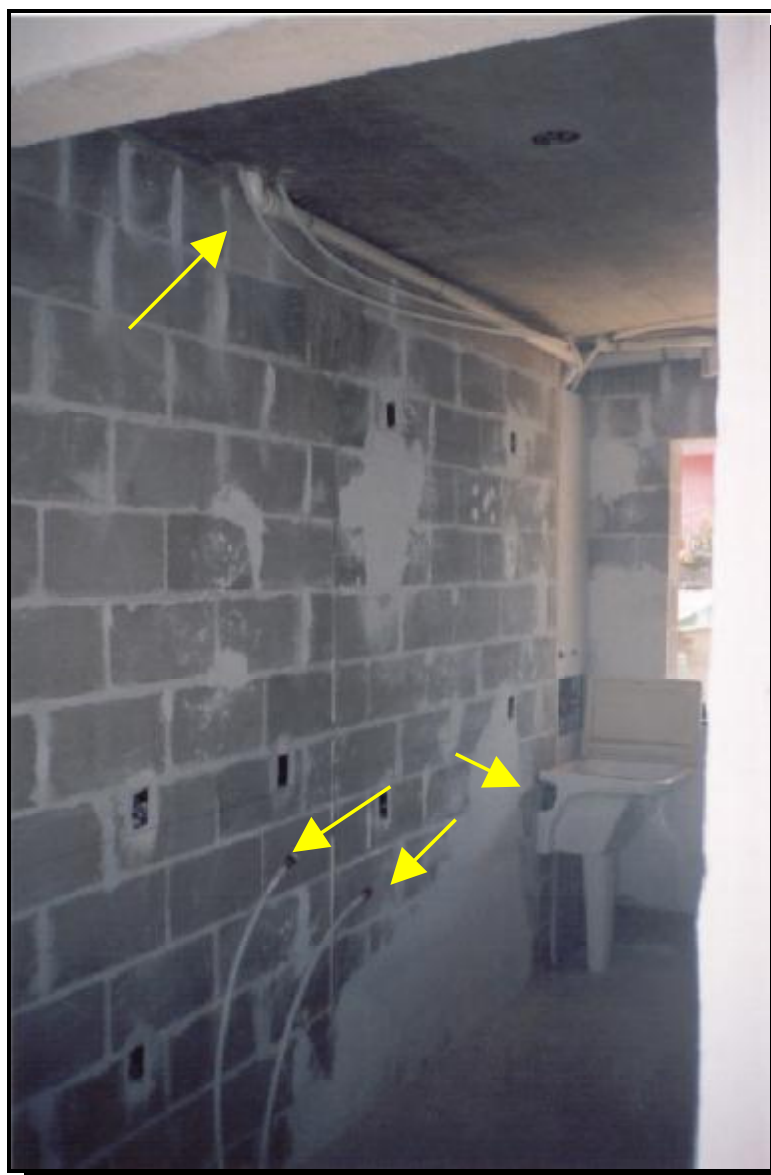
Instalações hidrossanitárias executadas com PVC e PEX externamente.
